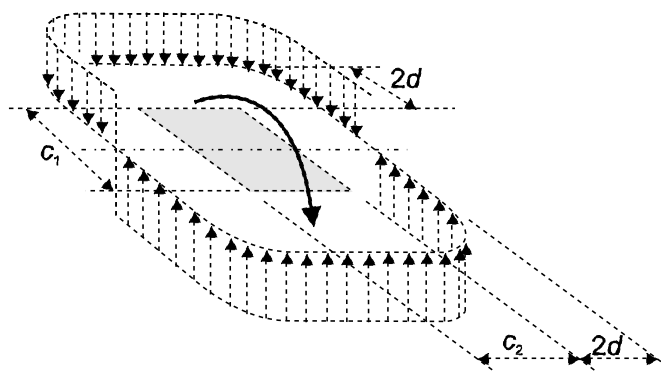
Распределение поперечного усилия при неуравновешенном моменте в узле «плита – внутренняя колонна»
